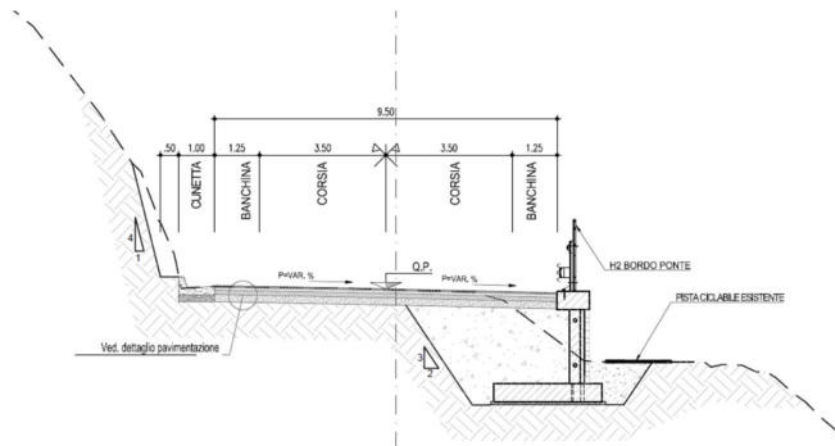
Sezione tipo con muro in progetto e pista ciclabile esistente (lato valle)
